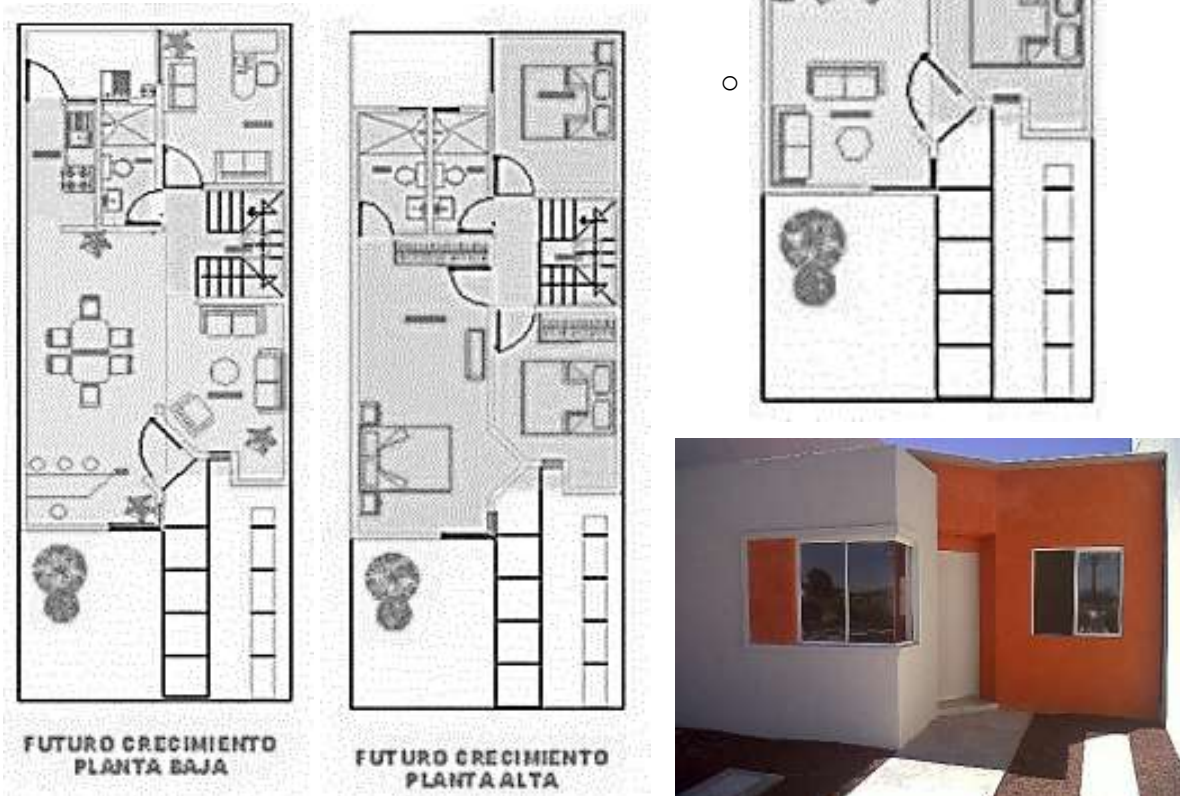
Planta arquitectónica e imagen de vivienda tipo. Fuente: elaboración propia. 2014
